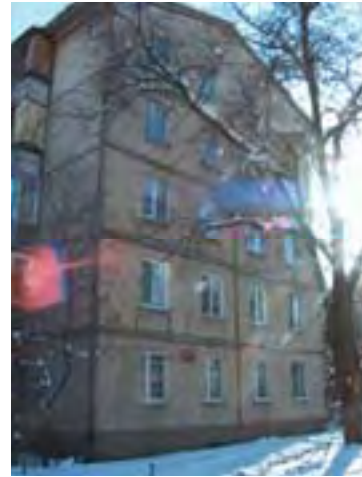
/5. Жилое здание, ул. Клочкова, 166
